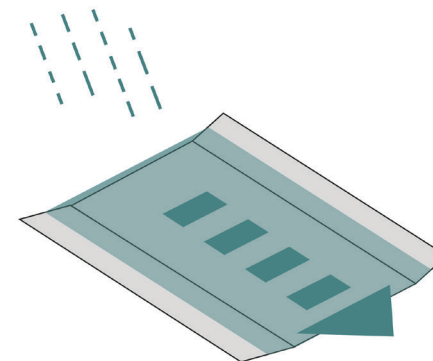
Blue Streets - Rückhaltung und/oder Ableitung (Notwasserweg) im Straßenraum [1]
